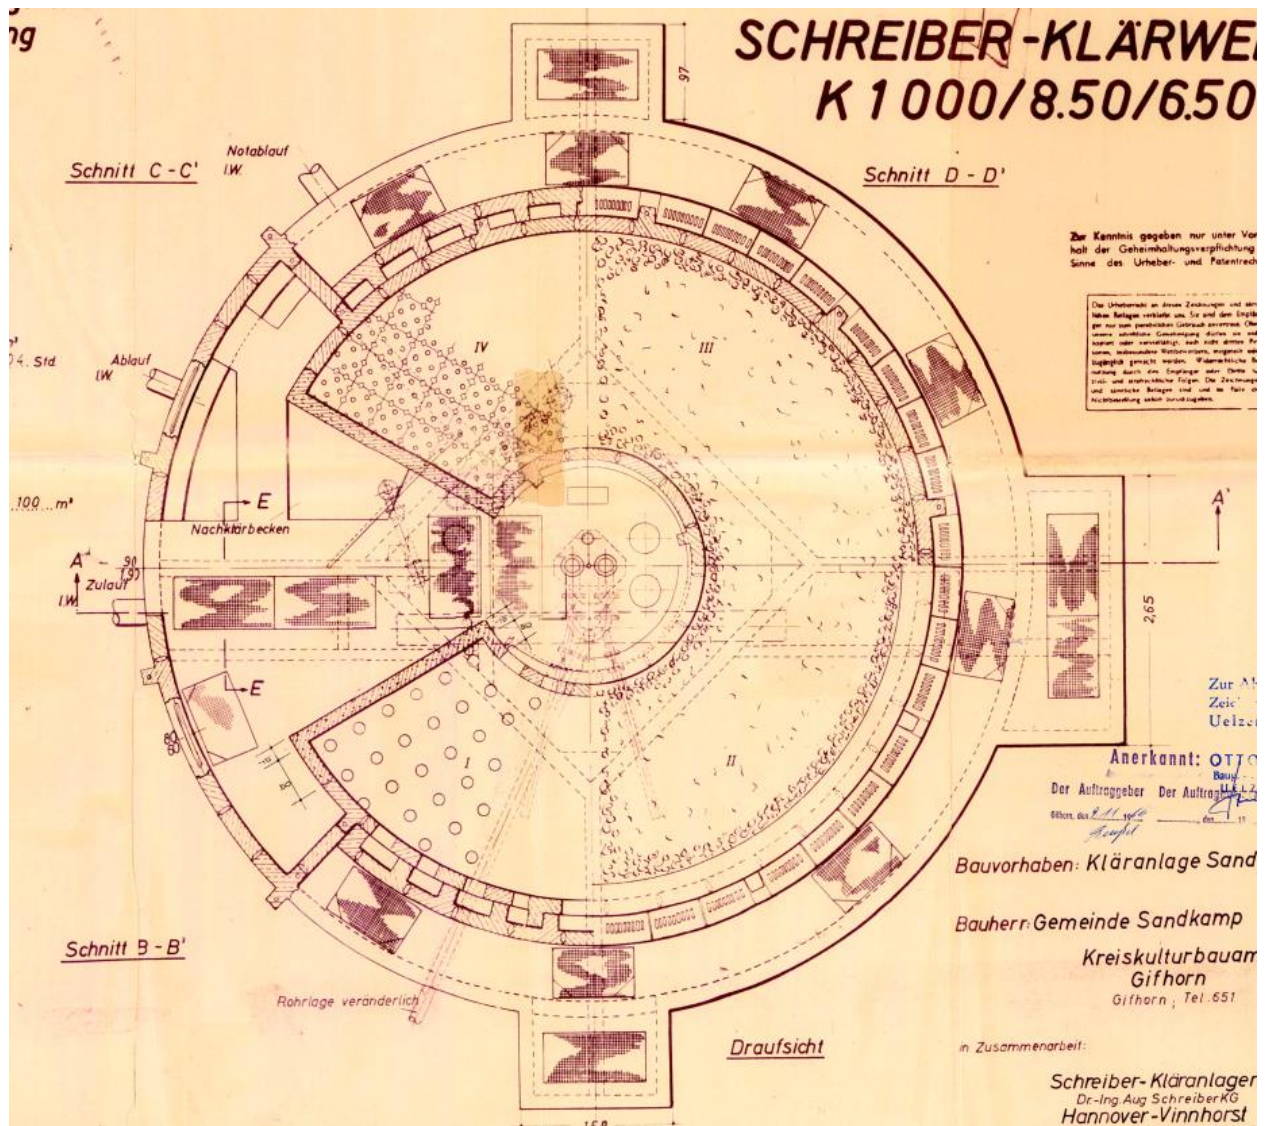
Grundriss - Ausschnitt aus Bestandsplan Tropfkörper KA Sandkamp. Die Gebäude wurden laut Aussage des AG baugleich ausgeführt
